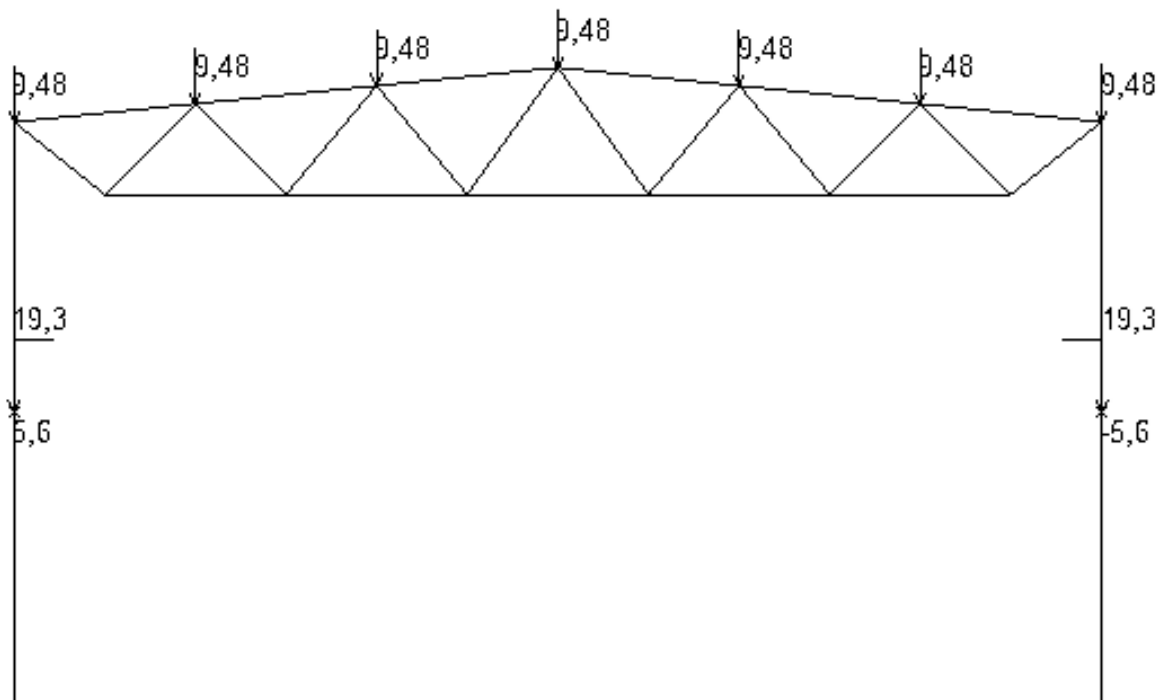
Схема приложения нагрузки от стенового ограждения и конструкций кровли
